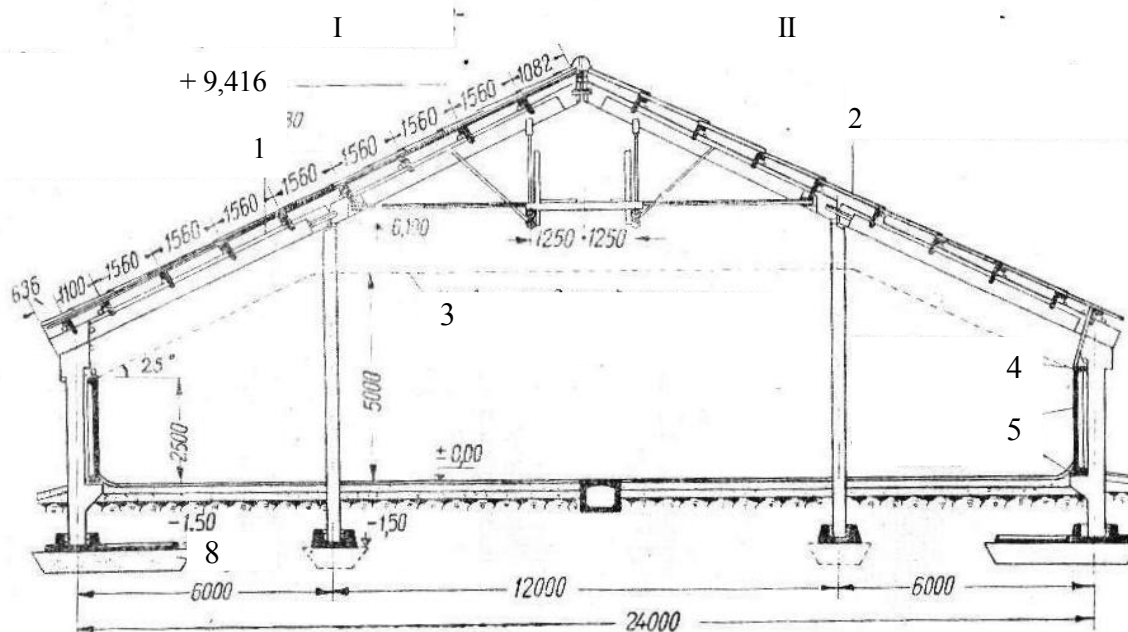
Поперечний перетин збірного залізобетонного зерноскладу типу 1956 р: I – Варіант перекриття азбестоцементними листами ВО; II – варіант перекриття азбестоцементними листами ВУ:
